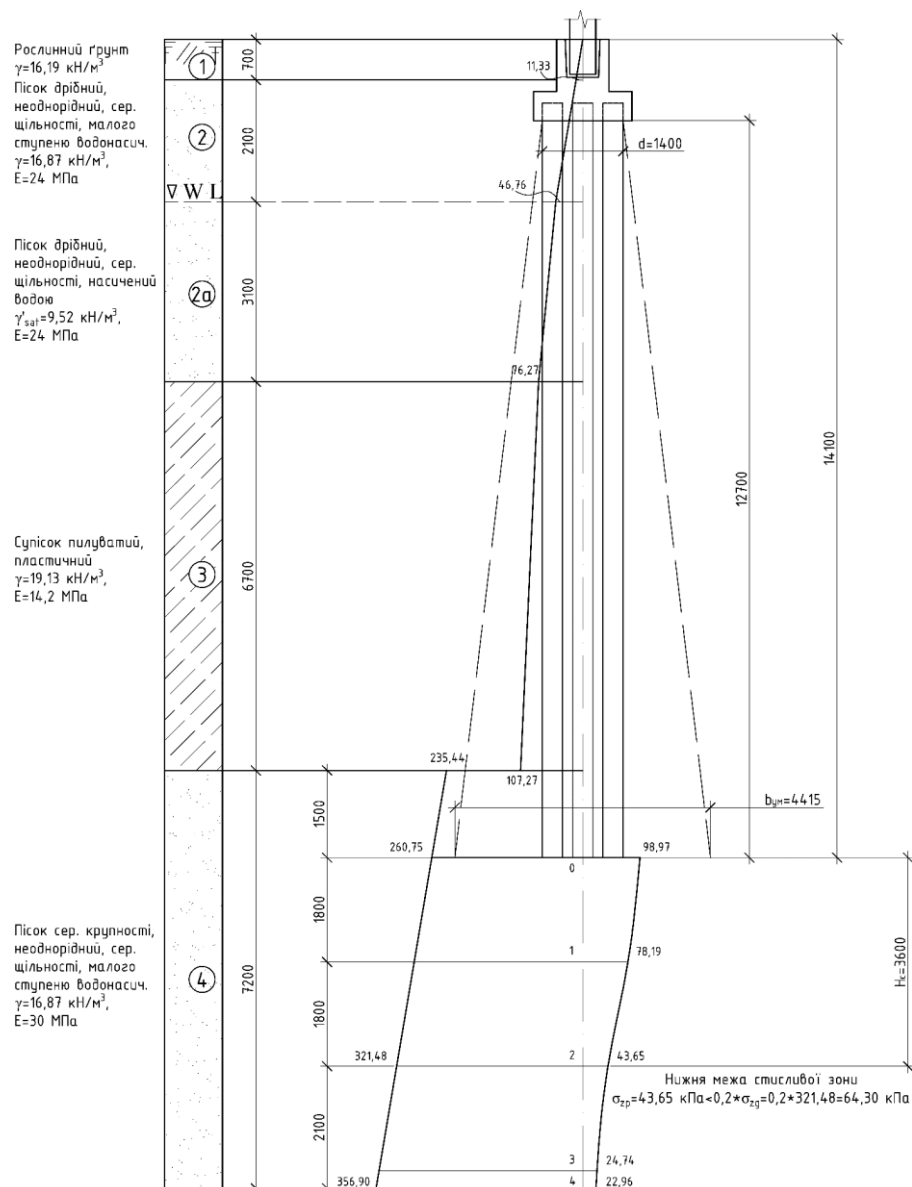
Розрахунок осідання основи пального фундаменту
